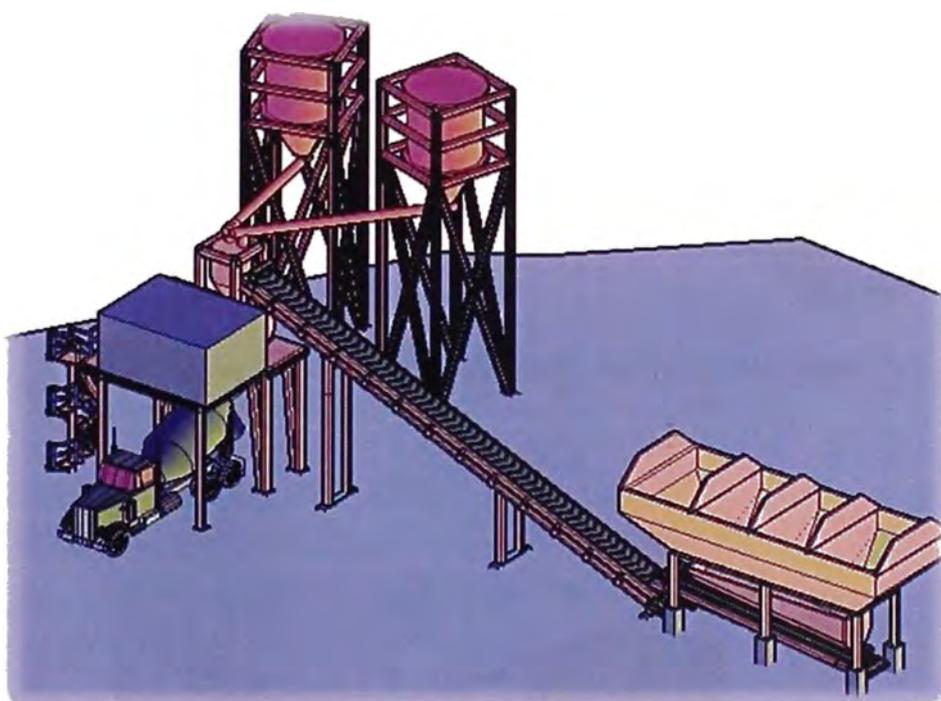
Planta de Concreto Estacionaria típica
